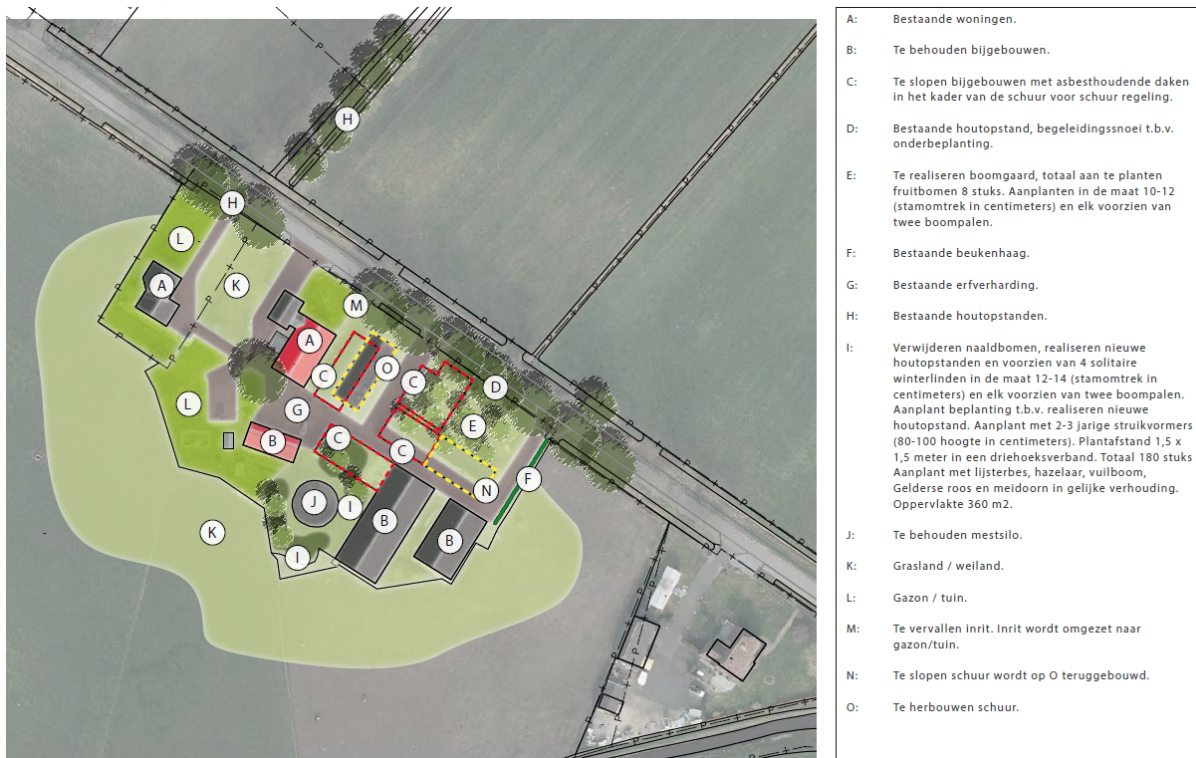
Overzicht van de te slopen gebouwen Loodijk 17
